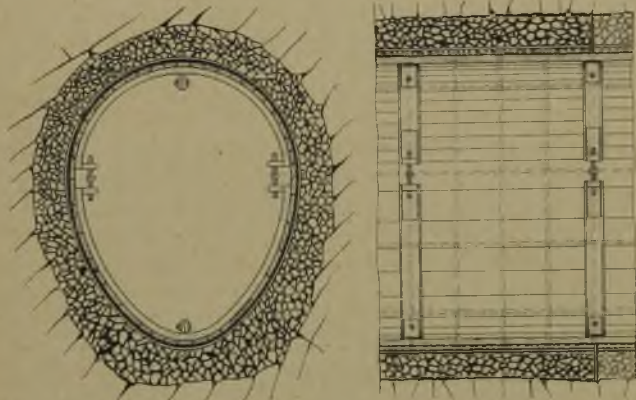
Querschnitt einer Stollenauskleidung mit Preßbeton.
